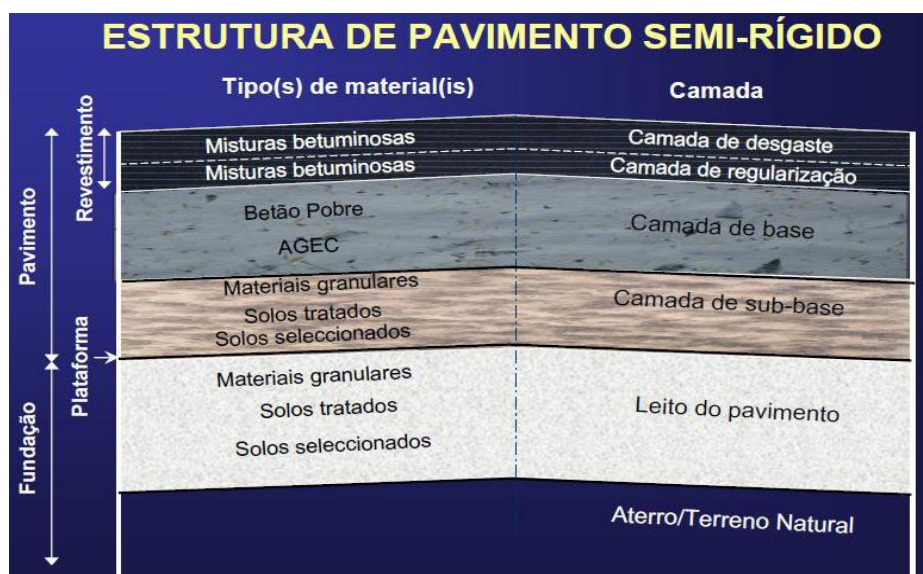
Pavimento Semi-rígido (BATISTA, 2009).
